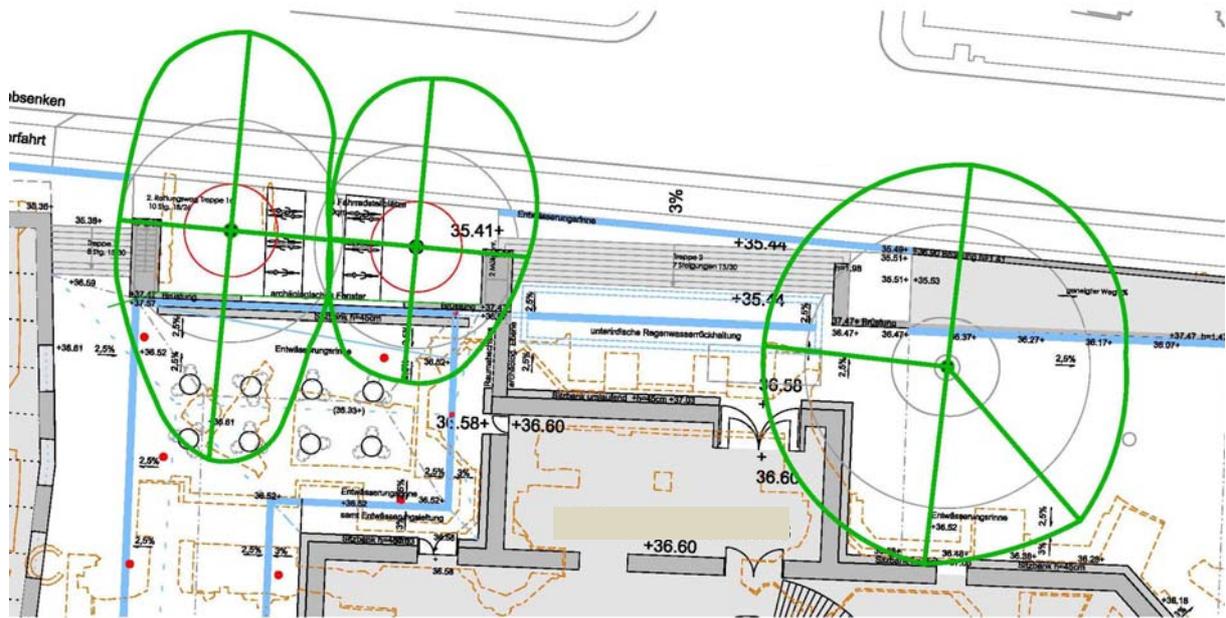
ungefähre Dimension der Baumkronen im Lageplan
